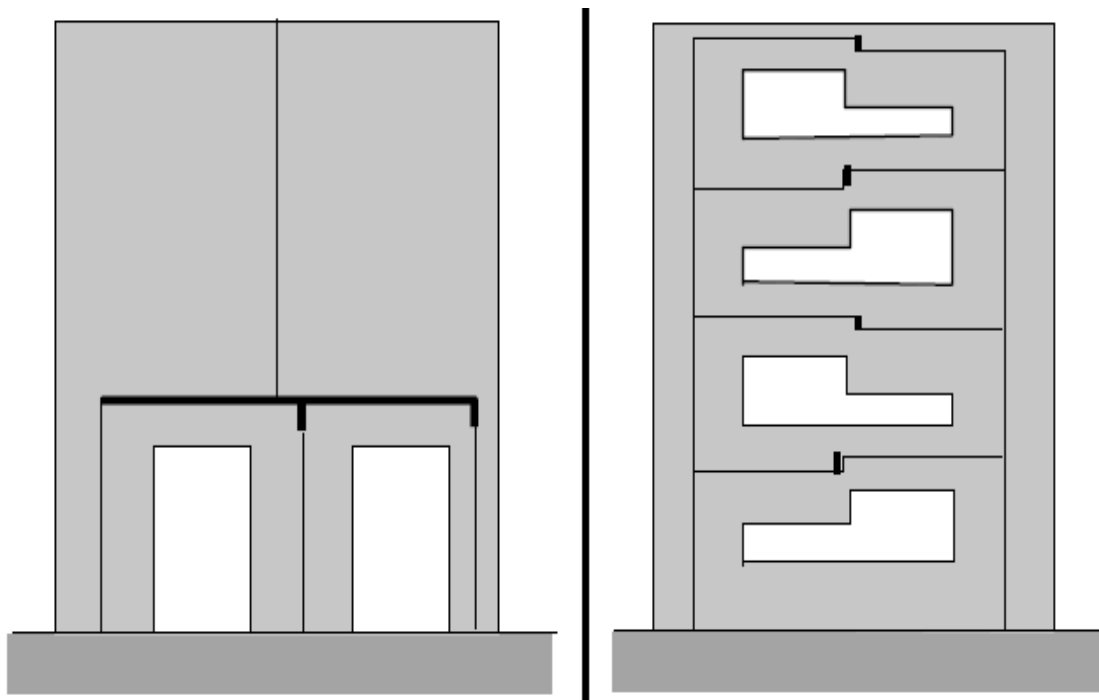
Estructura y marco equivalente para muro con aberturas alineadas.
